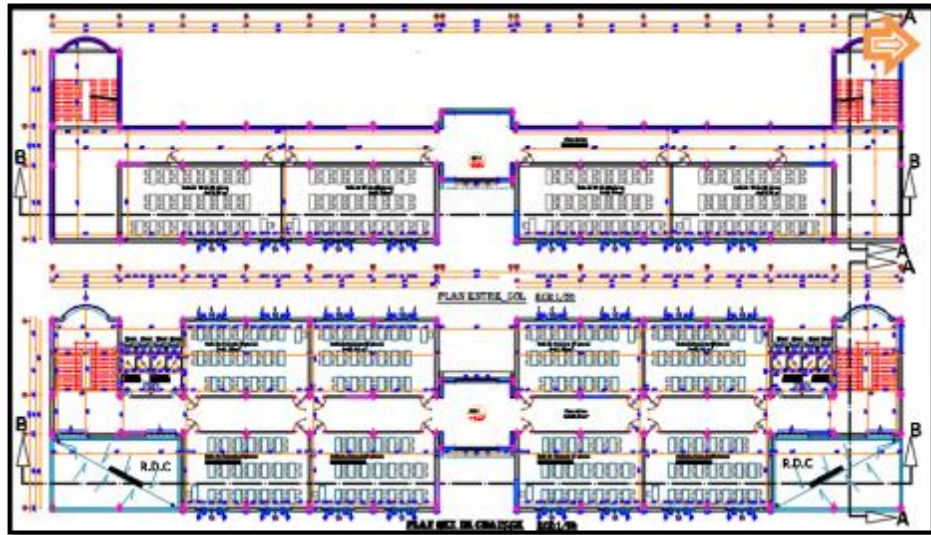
Plan R.D.C. Source : Bureau d'étude C.E.T.A.M.
